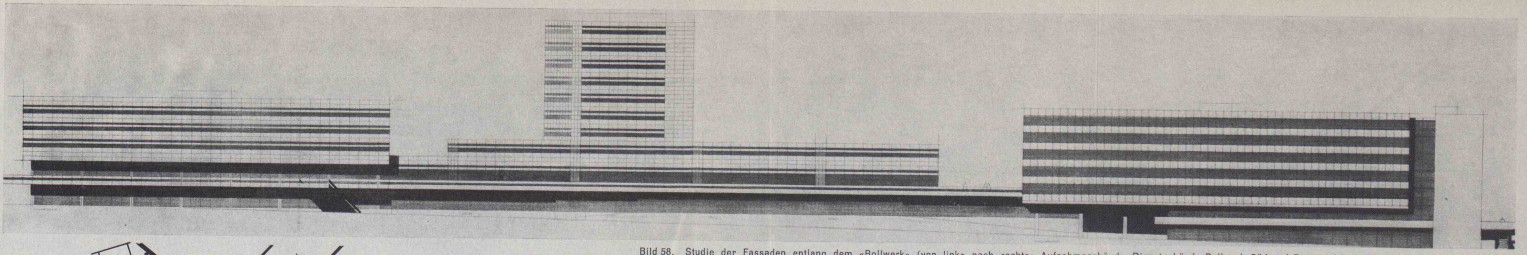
Studie der Fassaden entlang dem «Bollwerk» (von links nach rechts: Aufnahmegebäude, Dienstgebäude Bollwerk Süd und Dienstgebäude Bollwerk Nord mit Stellwerk 2)
